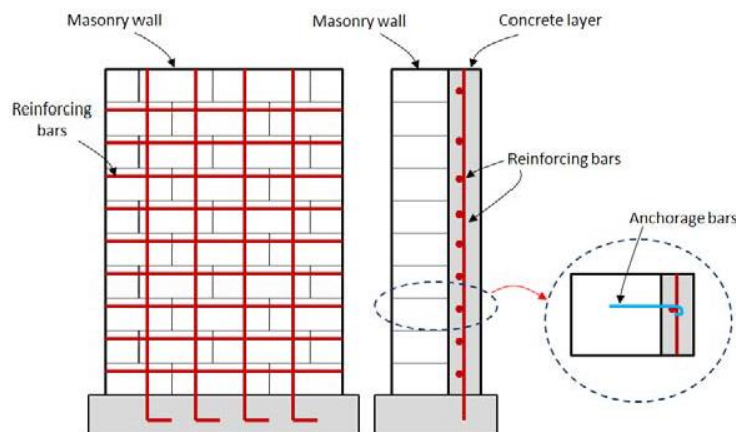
Renforcement d'un mur de maçonnerie avec une couche de béton armé [GHI.2012].
